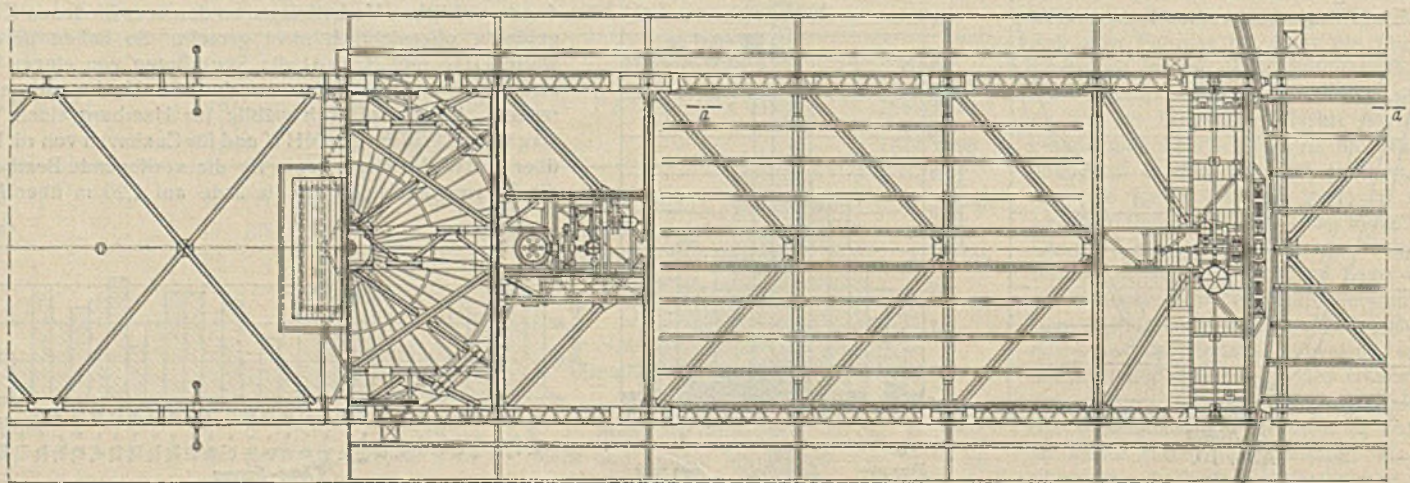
Drehbrücke mit Antriebsvorrichtung (Draufsicht).
